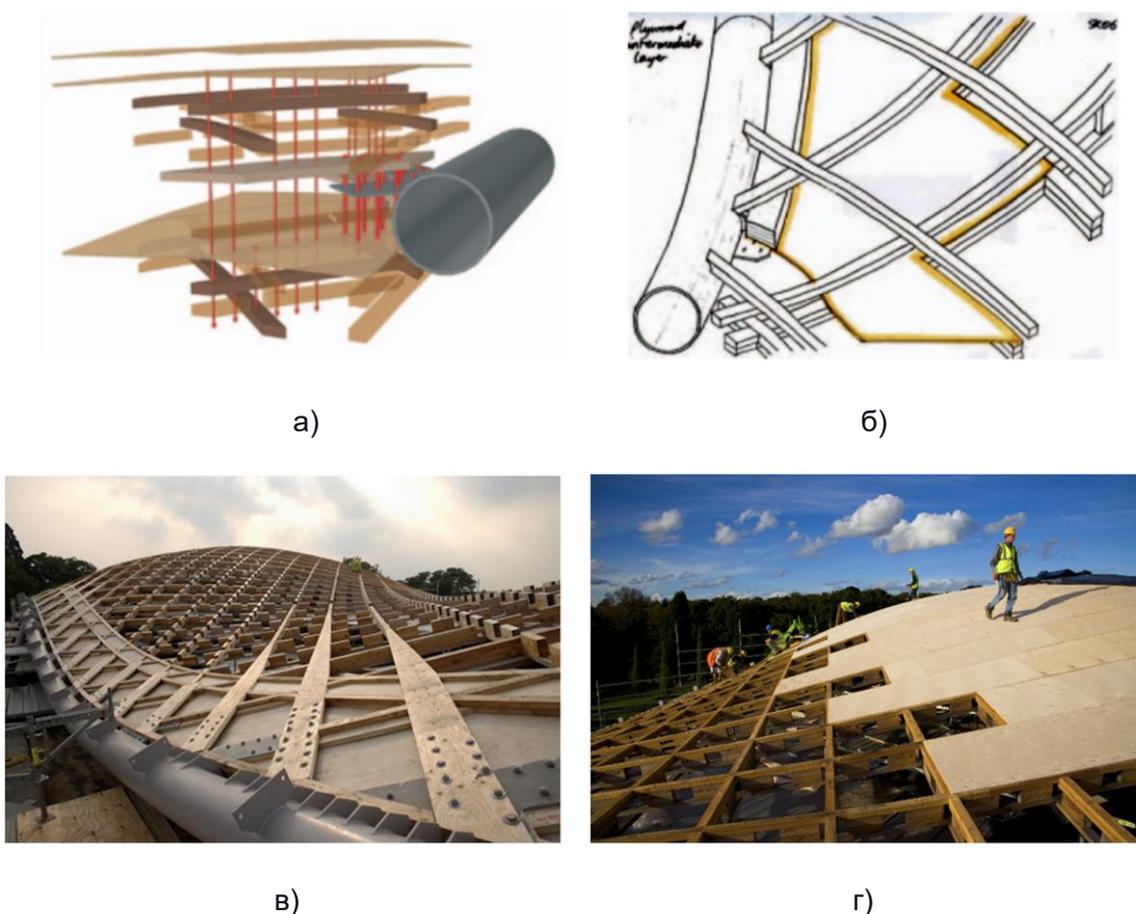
Соединения деревянной решетчатой оболочки со стальными конструкциями крыши Savill Garden: а, б) схемы контурных соединений; в, г) внешний вид оболочки на разных стадиях монтажа
